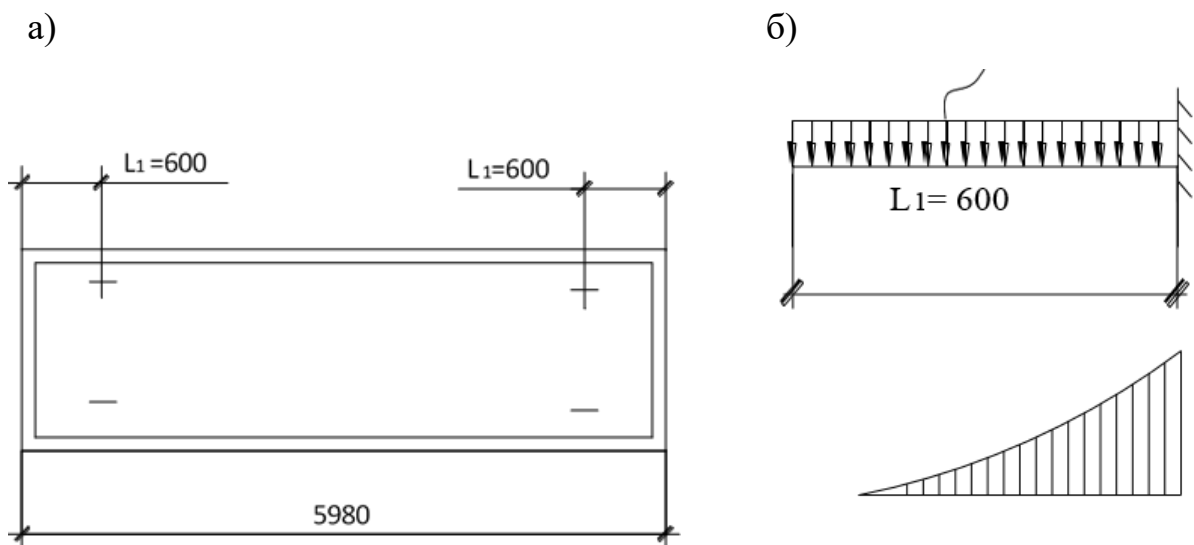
До розрахунку плити на монтажні зусилля:
